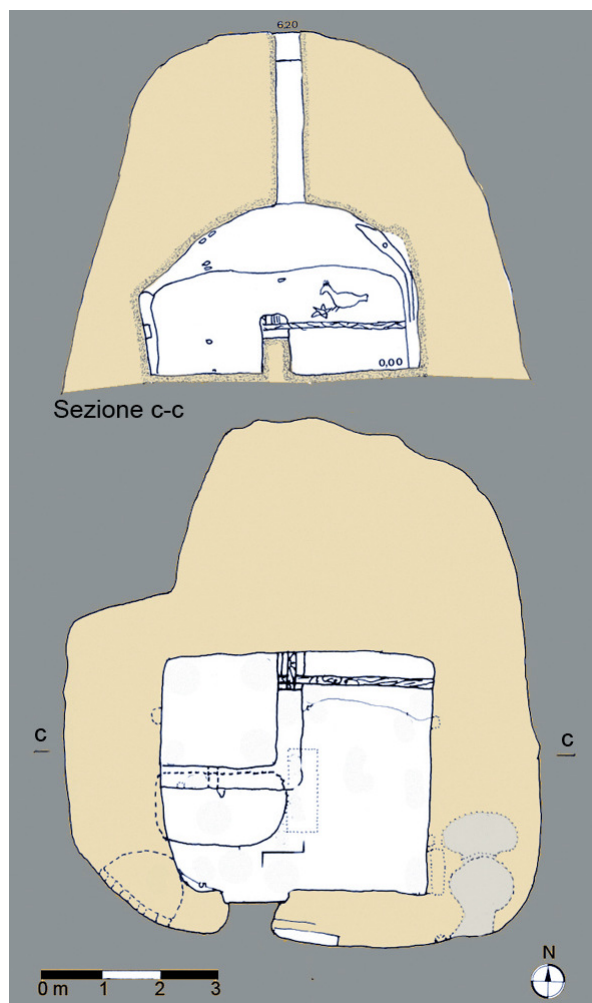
Schizzo planimetrico e sezioni delle Grotte della Gurfa
